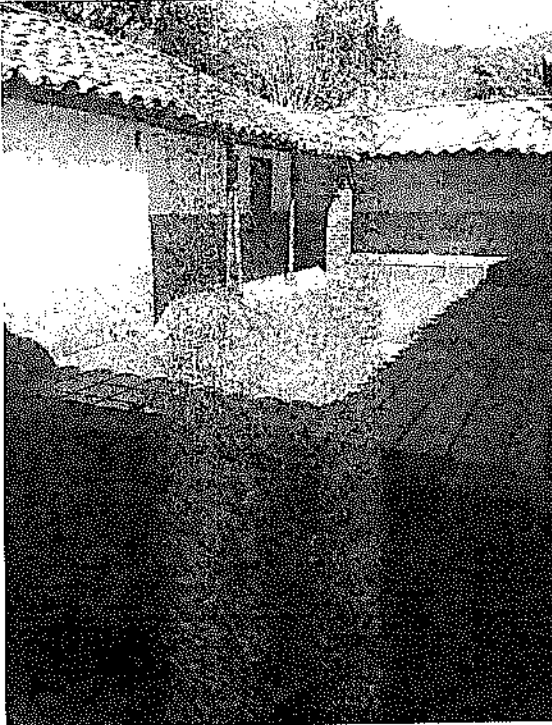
Modulo 2 zona admisnitrativa oficinas con baño
